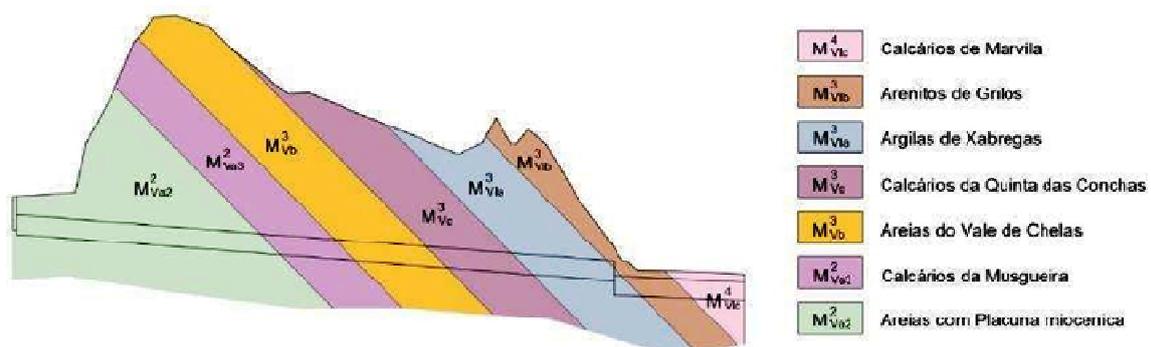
Corte geológico esquemático (sobrelevado 10x) das obras entre Chelas e o Beato (Fonte: Estudo Geológico Geotécnico)
